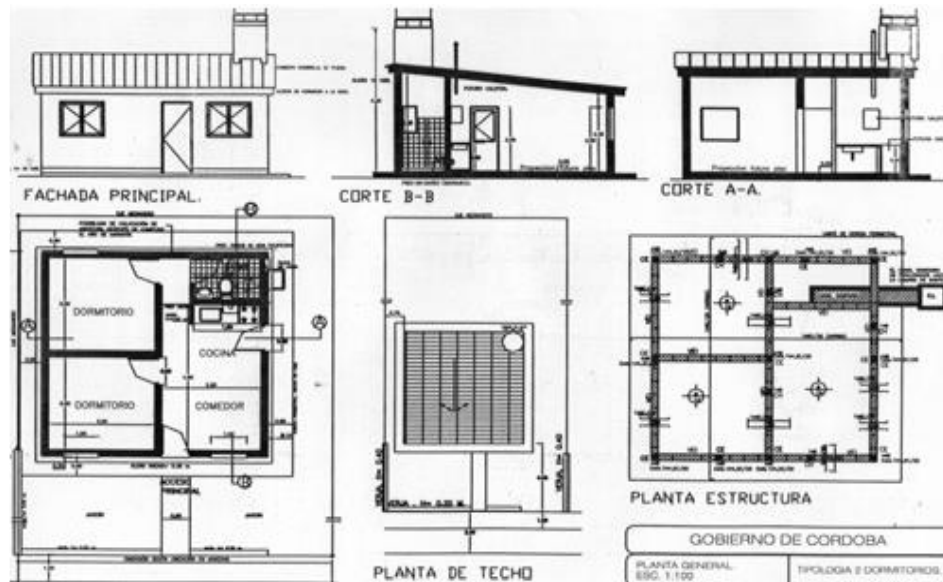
Plano oficial de las viviendas de las Ciudades-Barrio.
